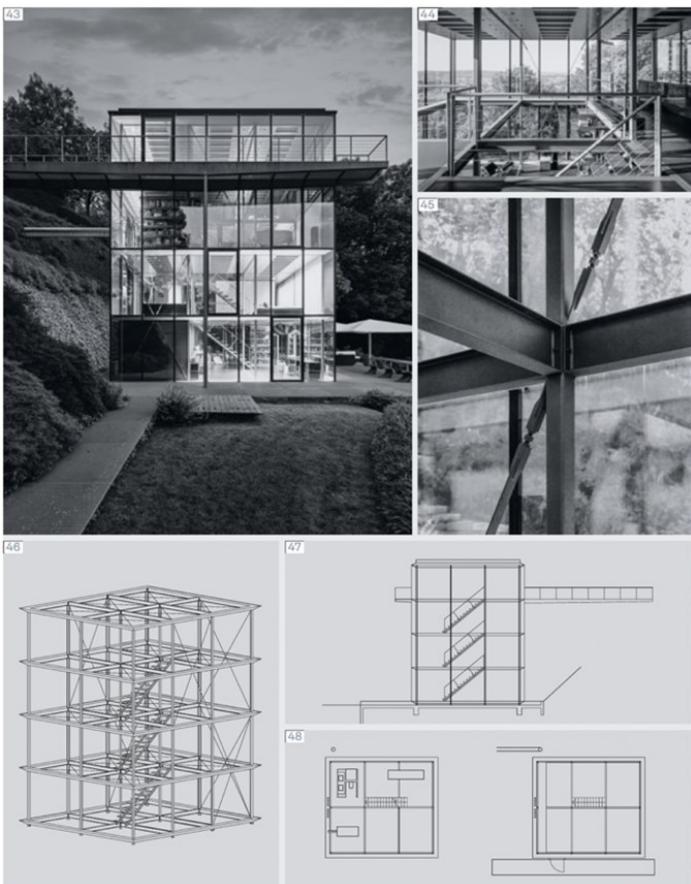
从左到右: 建筑外景; 开放的室内空间, 没有隔断墙, 仅由玻璃分隔; 主体结构连接细部; 结构轴测图; 纵向剖面图; 首层平面图及顶层平面图 ©ROLAND HALBE
